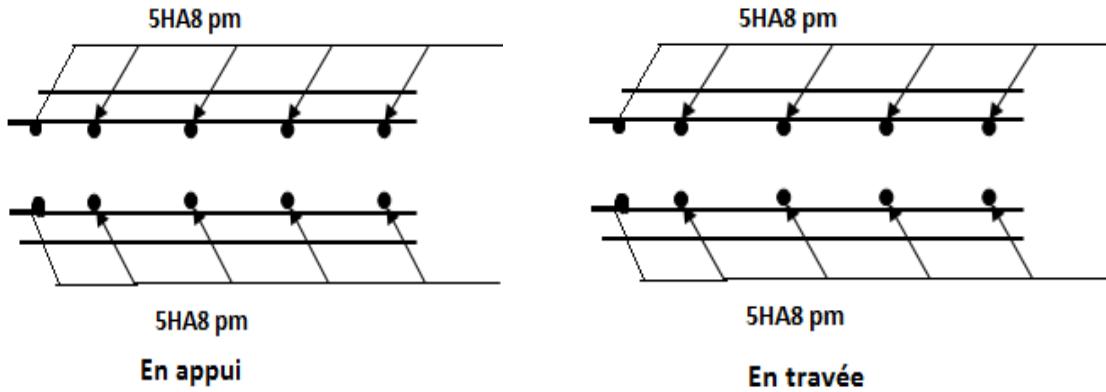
coupe transversale de Schéma de ferrailage de la dalle de l'ascenseur
